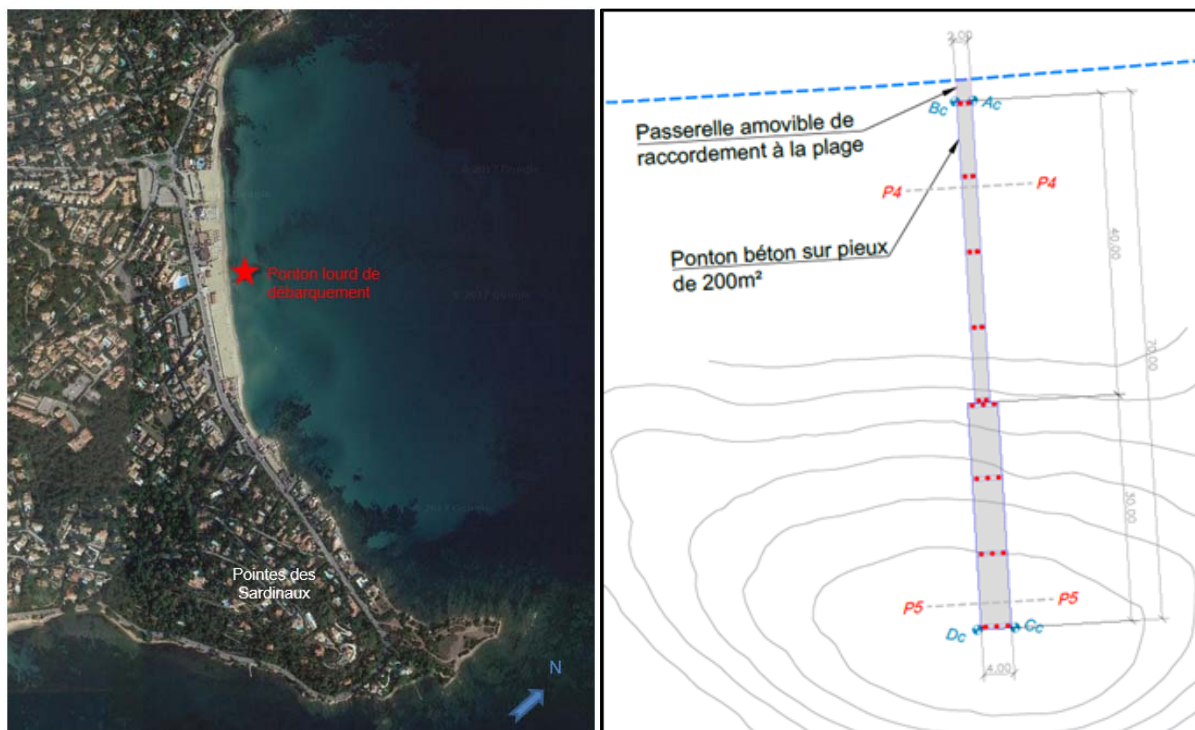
Cartographie du site d'implantation et vue en plan du ponton sur pieux de la Nartelle
